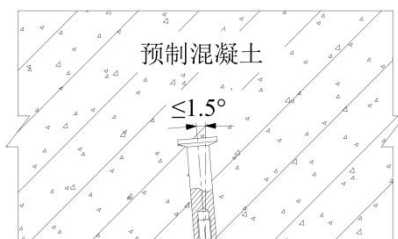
预制混凝土套筒预埋倾斜误差要求
